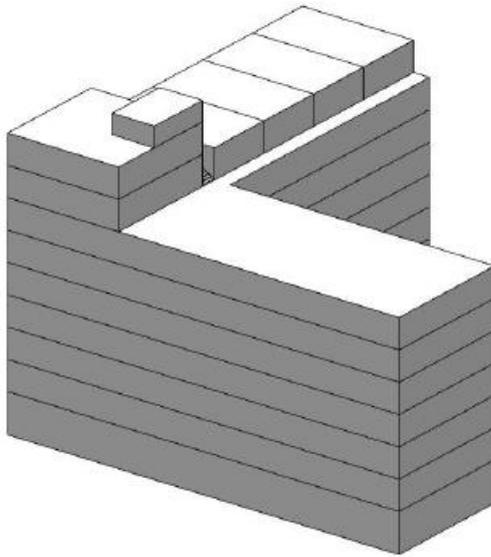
Darstellung Eckaufstockung mit Führung des Rettungsweges über Dachflächen und Rettungsgereäte der Feuerwehr
